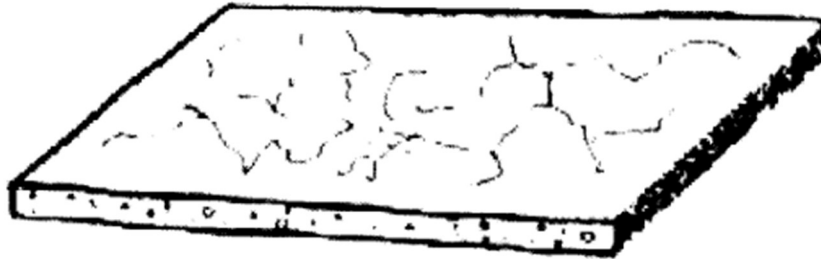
Agrietamiento en placa de hormigón
